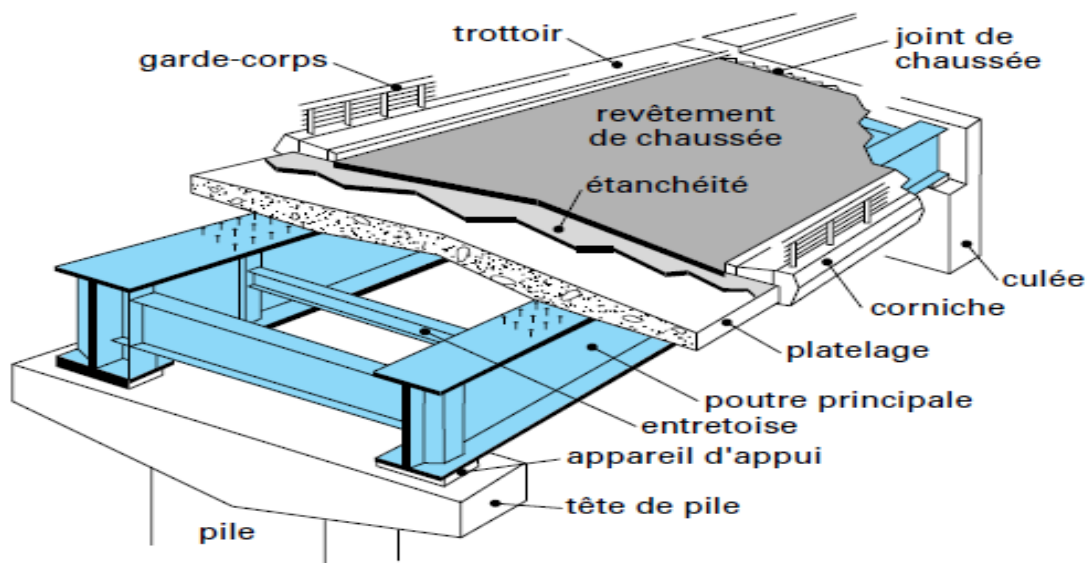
schéma descriptive d'un Pont mixte bipoutres
